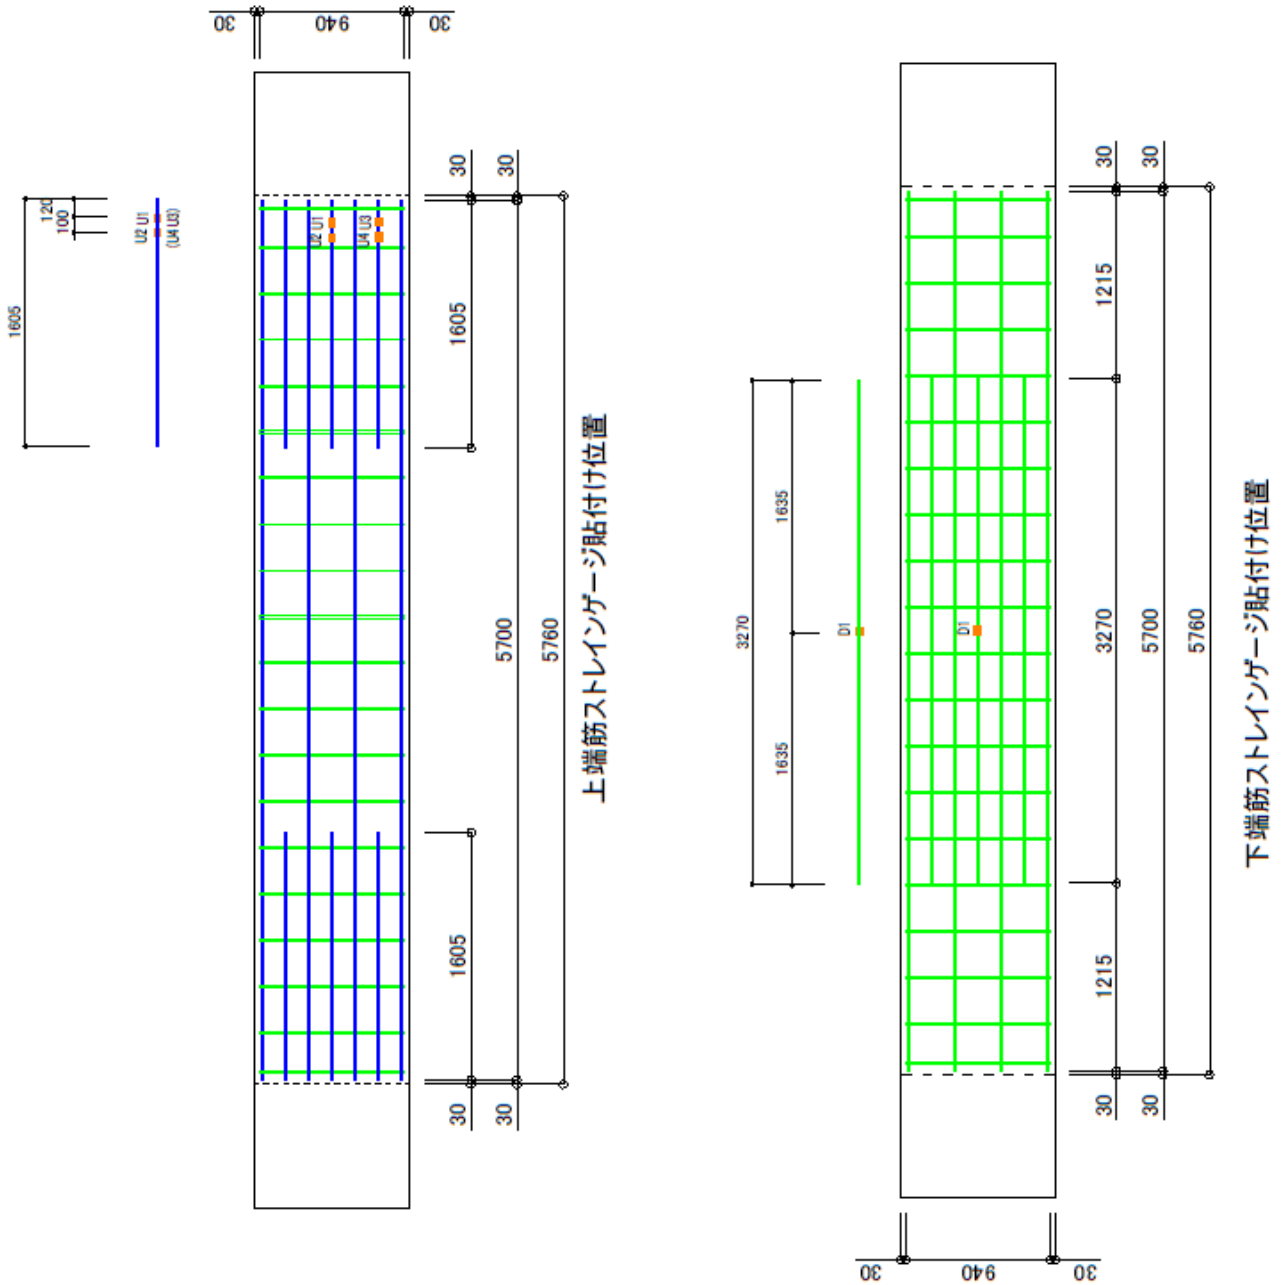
鉄筋(スラブ筋)ひずみ測定位置(AH, BA 試験体)
